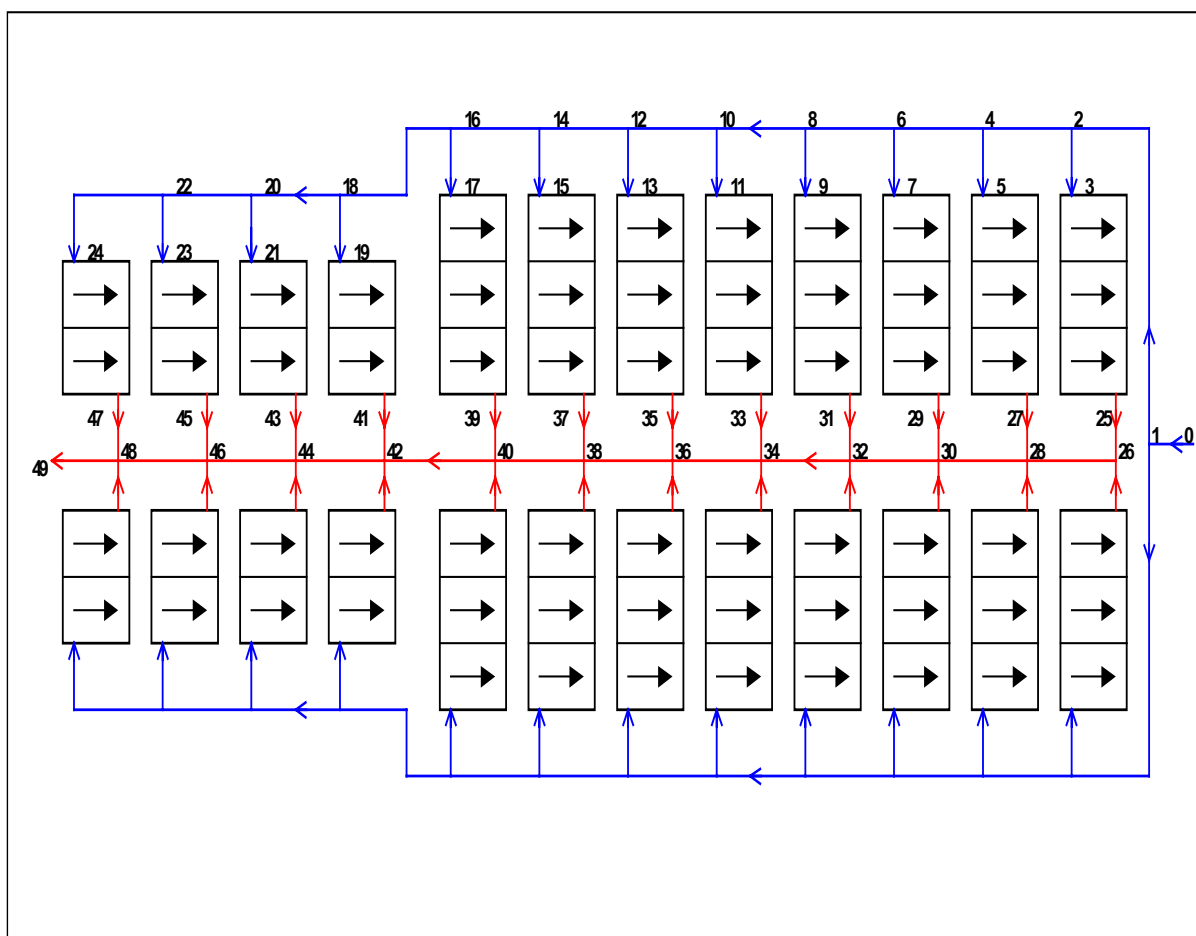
a. Esquema de conexión de colectores y tuberías en cubierta
